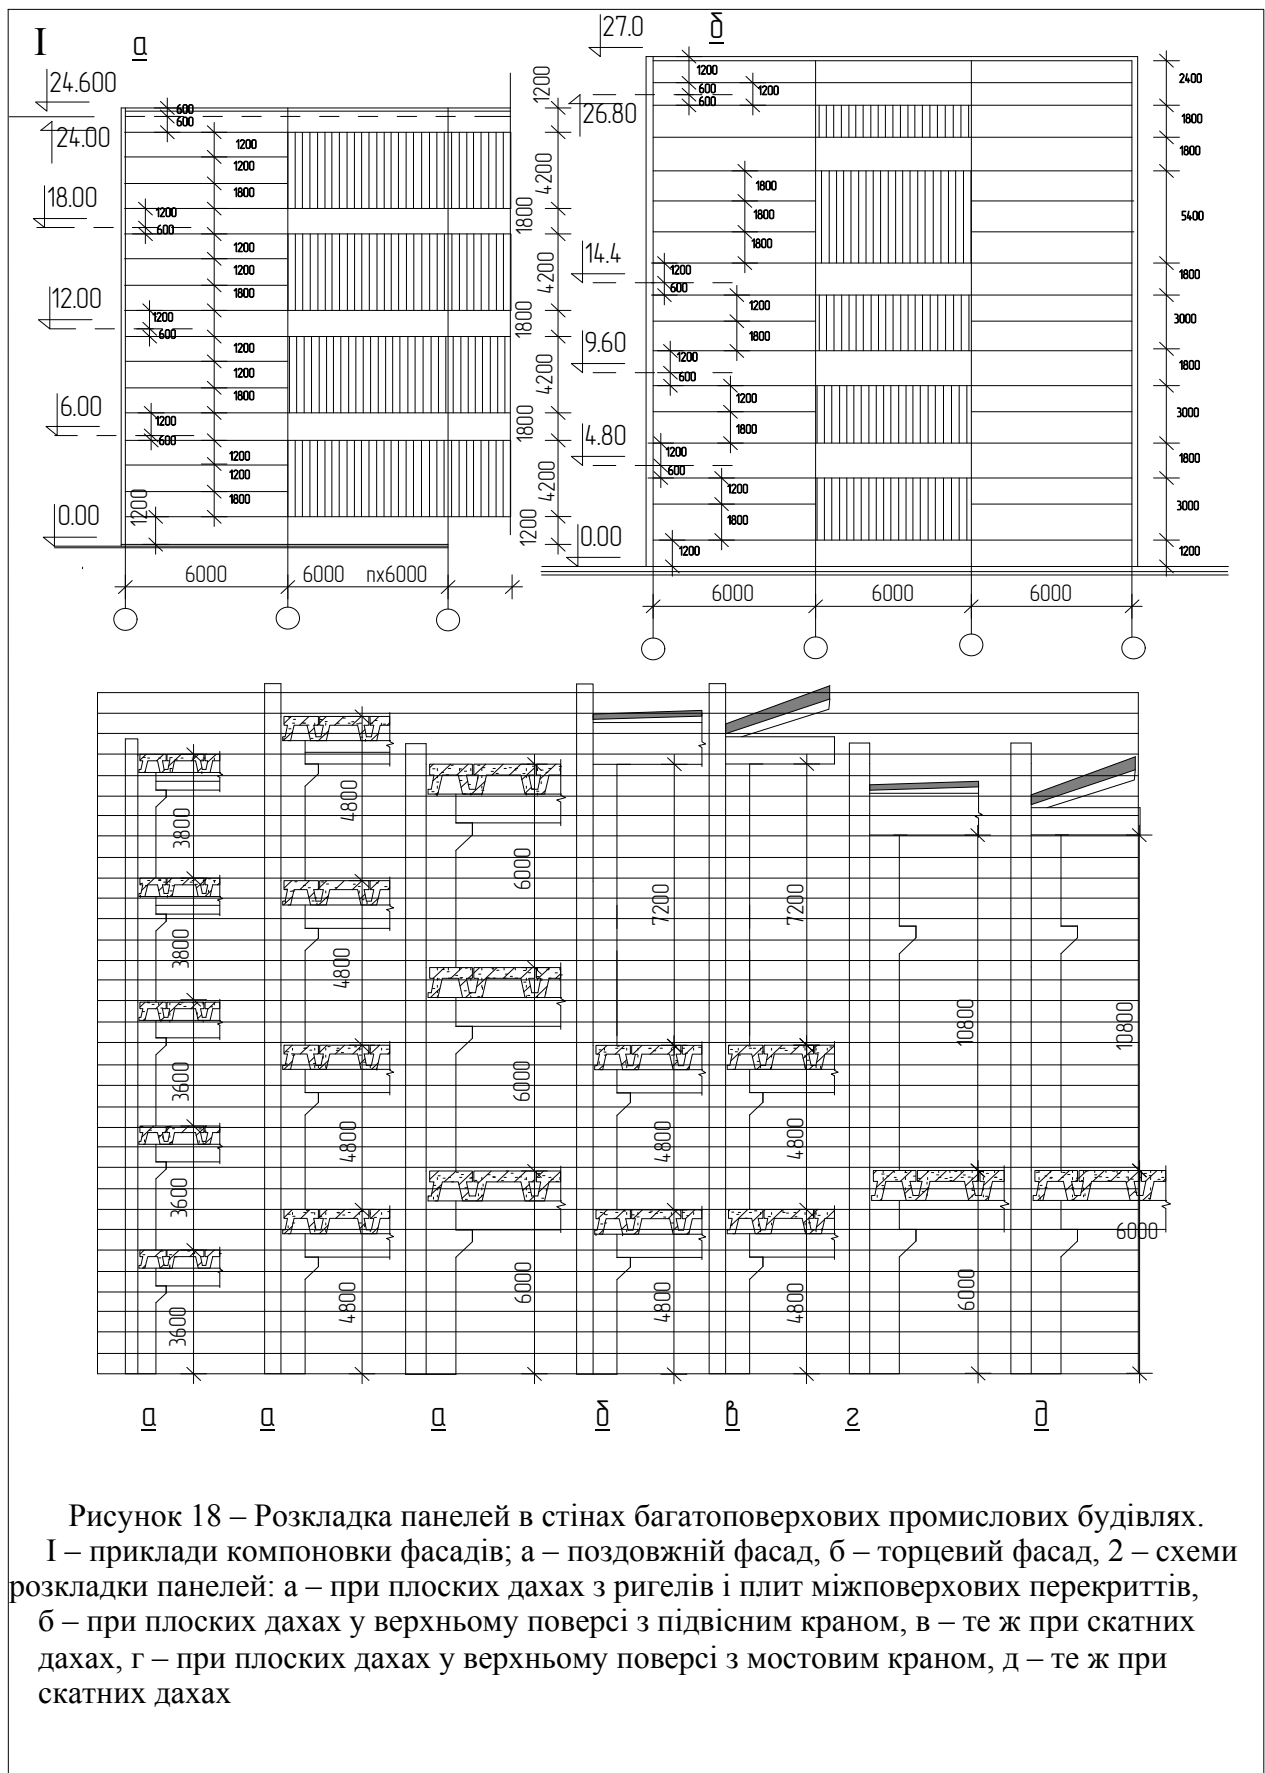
Розкладка панелей в стінах багатоповерхових промислових будівлях. I – приклади компоновки фасадів; а – поздовжній фасад, б – торцевий фасад, 2 – схеми розкладки панелей: а – при плоских дахах з ригелів і плит міжповерхових перекриттів, б – при плоских дахах у верхньому поверсі з підвісним краном, в – те ж при скатних дахах, г – при плоских дахах у верхньому поверсі з мостовим краном, д – те ж при скатних дахах
